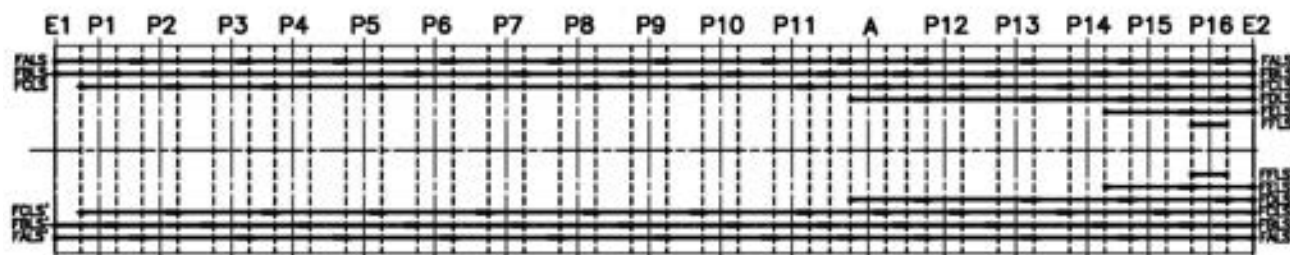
Planta del pretensado de lanzamiento superior del viaducto sobre Río Deza
